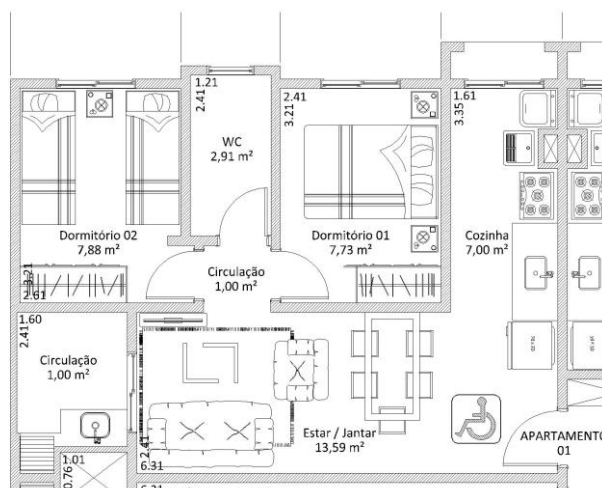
Apartamento tipo 1- Projeto 2. Fonte: RDB Construtora.
